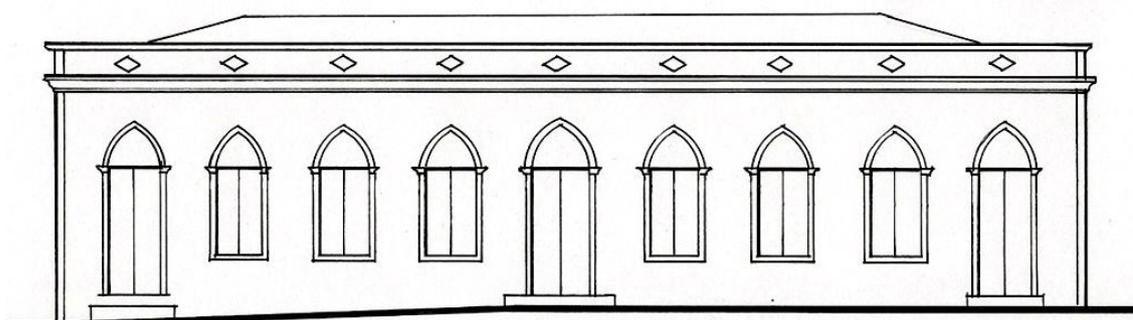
Fachada principal do primeiro Grupo Escolar de Baturité - praça Waldemar Falcão
